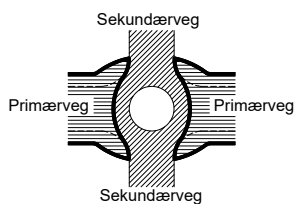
Ansvarsdeling i planskilt kryss med rundkjøringer på sekundærveg
